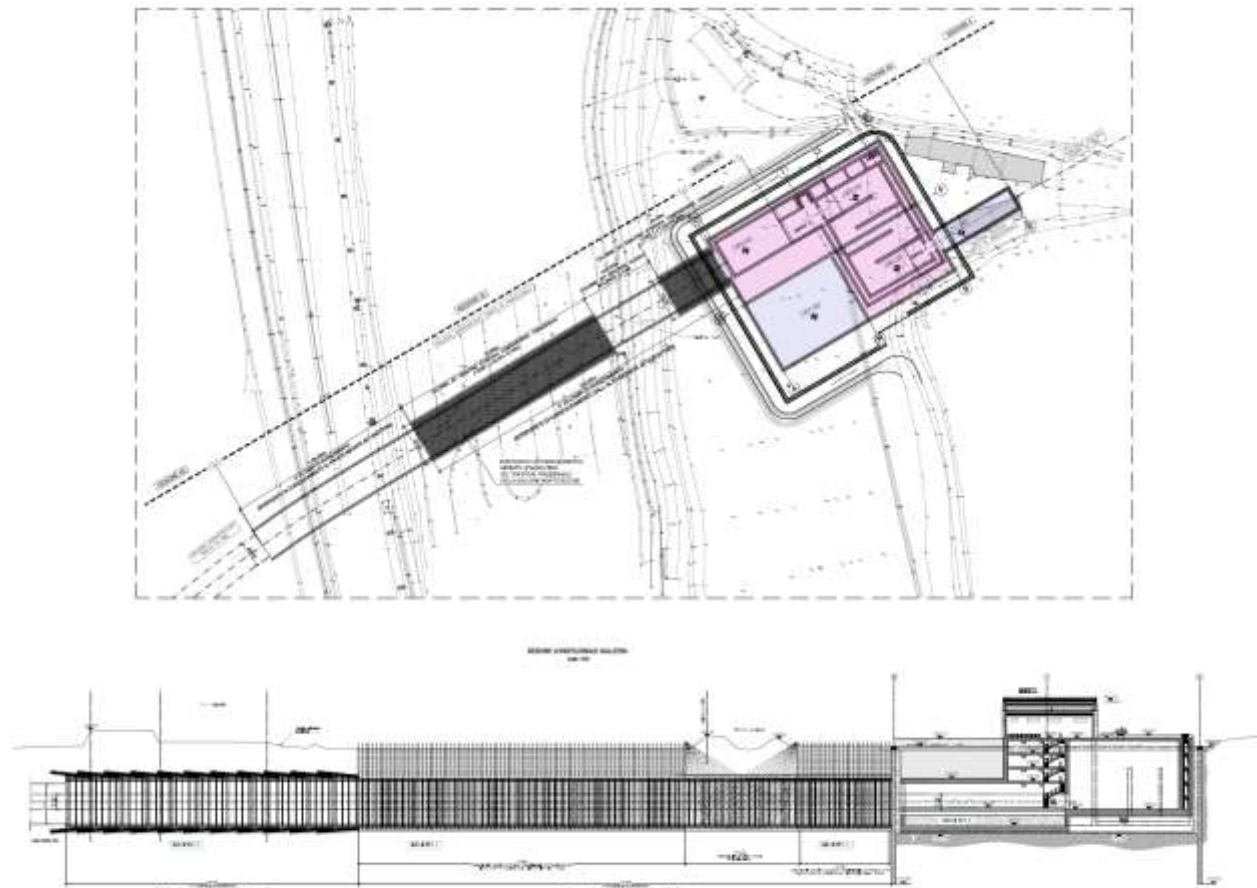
Planimetria e sezione imbocco galleria Montevecchio
